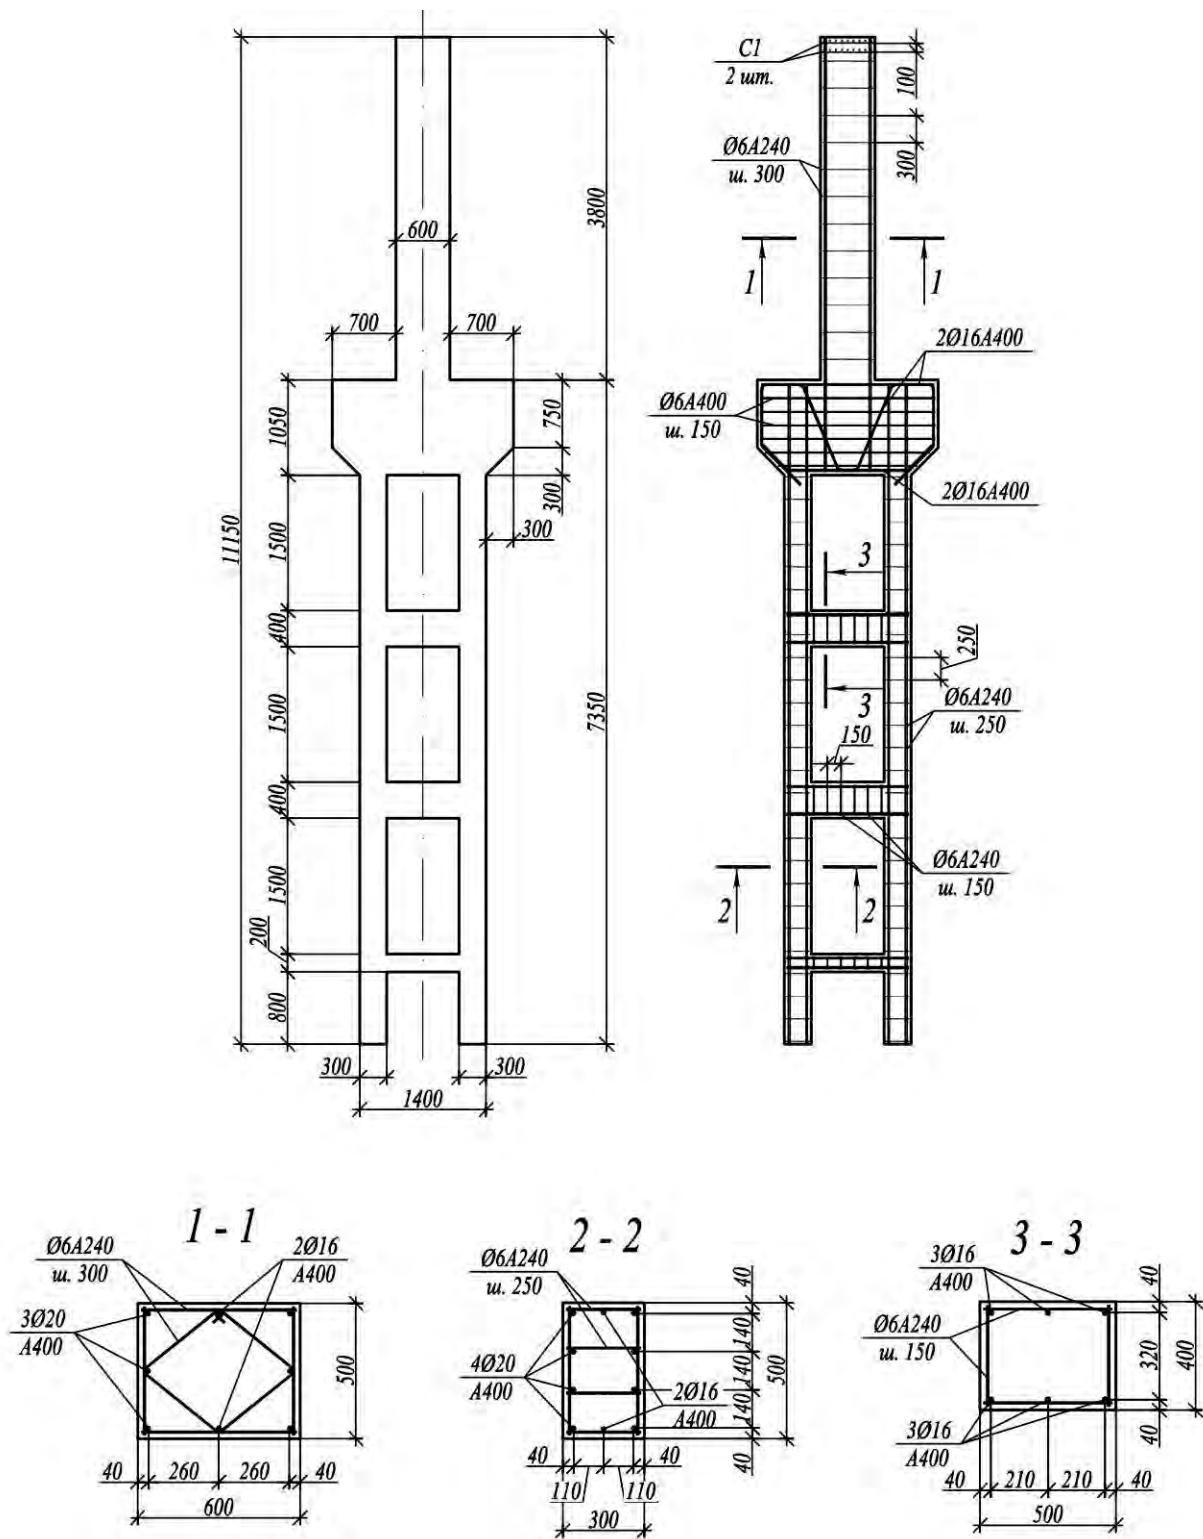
Опалубочный чертеж и схема армирования двухветвенной колонны
